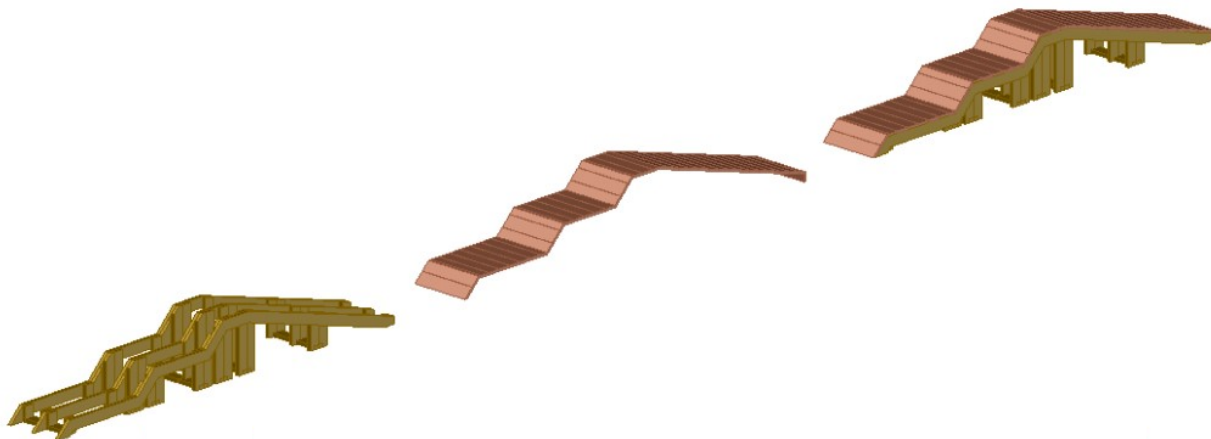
Estrutura, revestimento e elemento completo, respectivamente.
